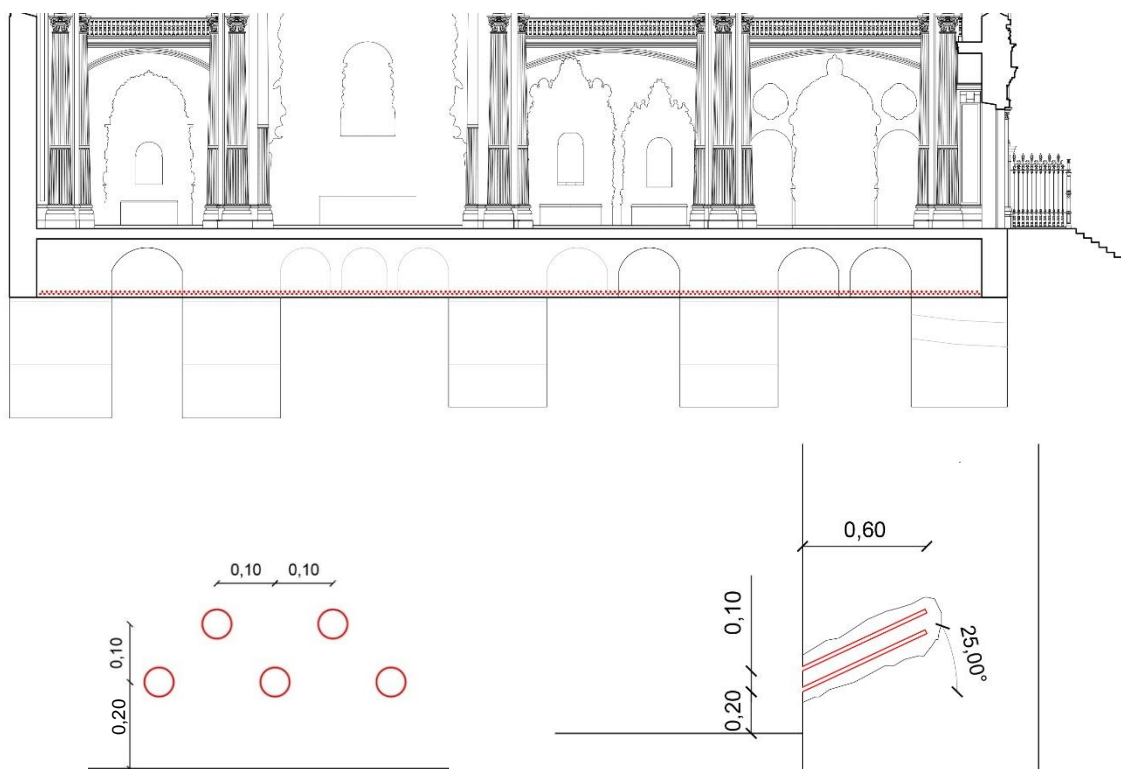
Colocación de sistema de desecación Knapen. Alzado interior Sur (arriba) y detalle de colocación (abajo)
